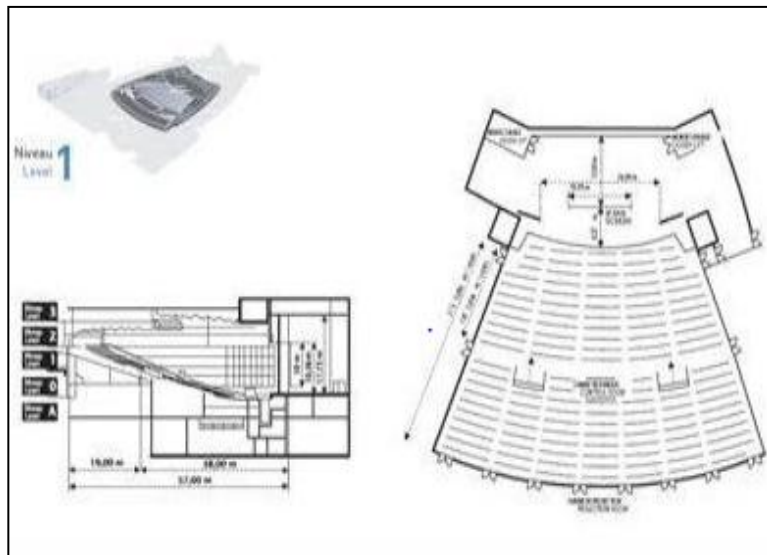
Coupe et plan du grand amphithéâtre du palais
